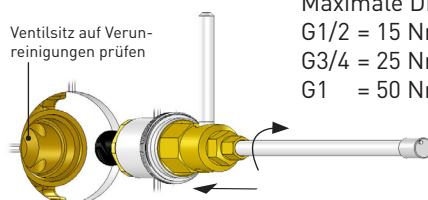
Anschlussarmatur/Ventilsitzkolben einschrauben
